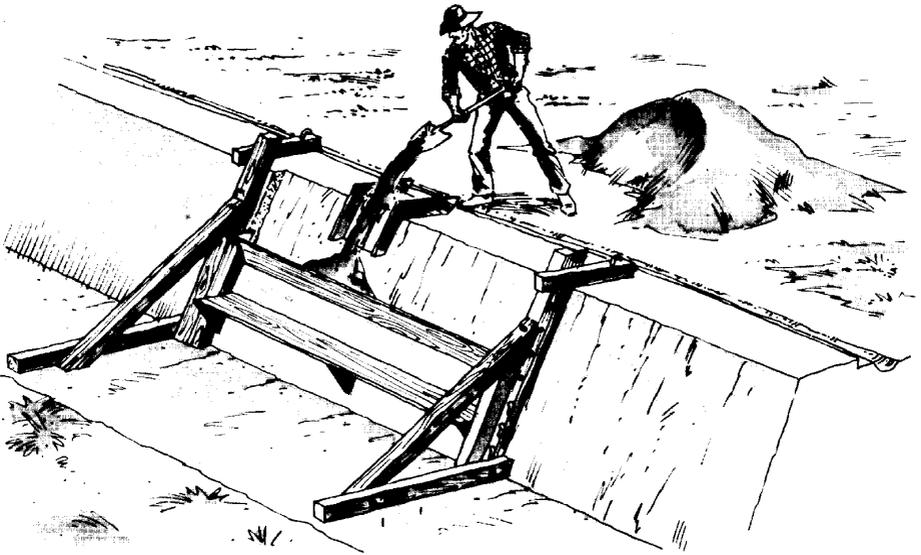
Lançamento do solo-cimento na fôrma durante a construção de silo-trincheira com painéis monolíticos
